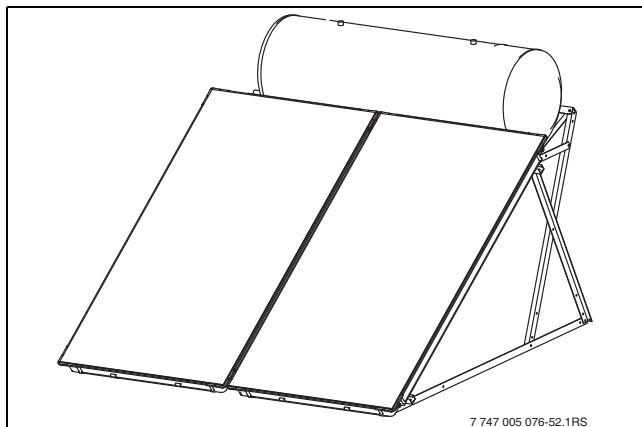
Vista montaje en cubierta plana (sistema de 300 l)
